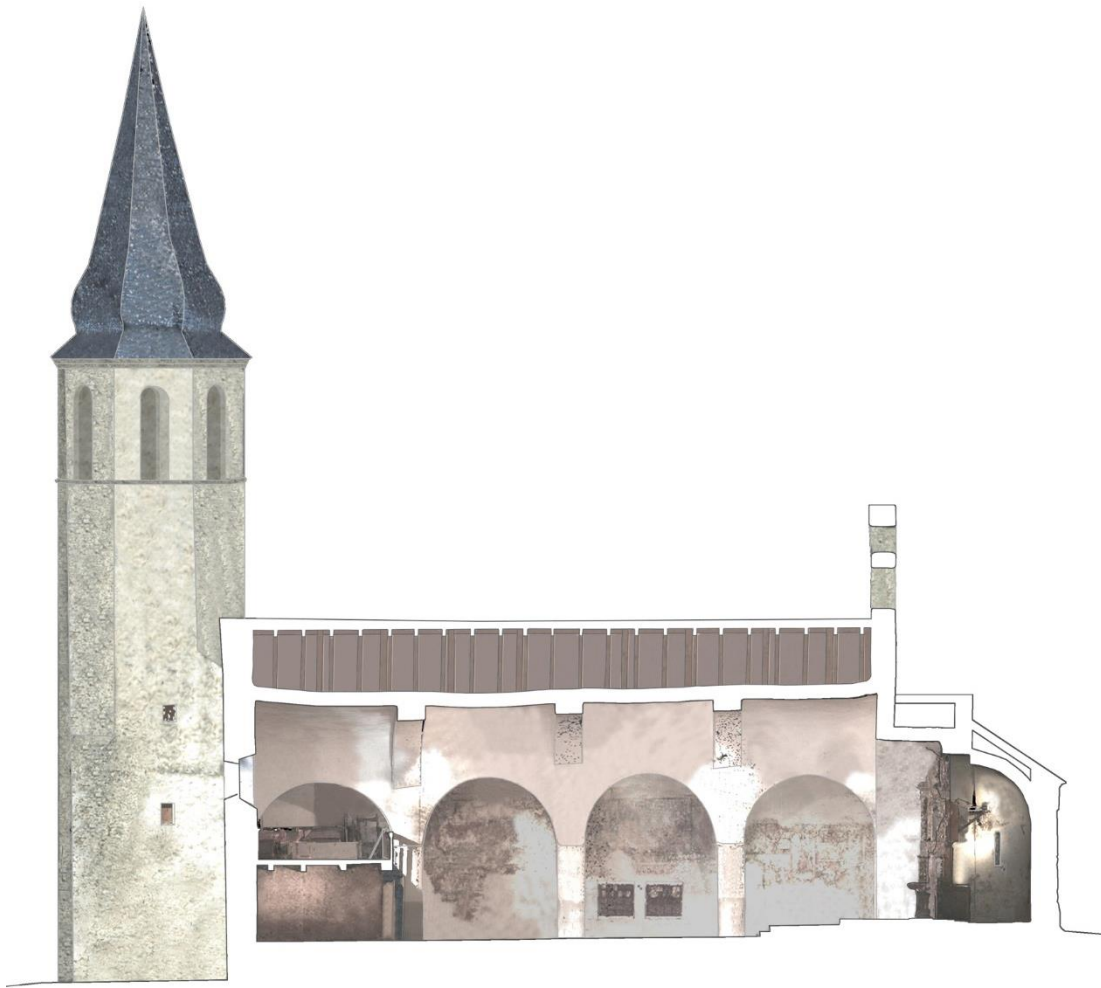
Planimetría de la Iglesia de Santa Eulària d'Unha. e.:1/200.
